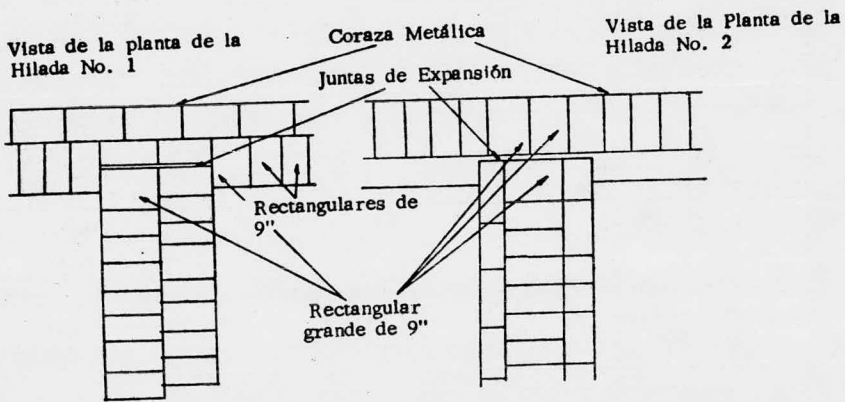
Juntas de expansión para pared Intermedia Hiladas cuatrapeadas.
